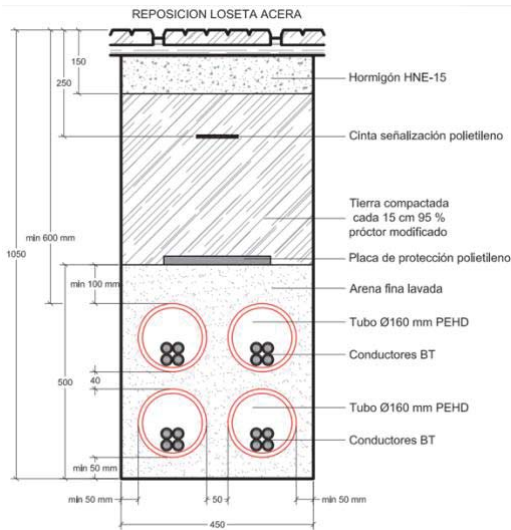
Norma de la compañía eléctrica para la construcción de zanjas eléctricas bajo aceras Fuente [\(10\)](#)
